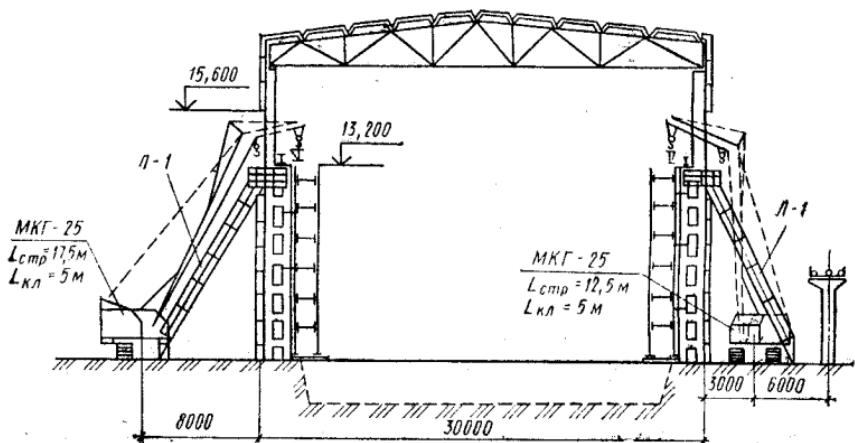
Замена подкрановых балок в действующем цехе через оконные проемы
